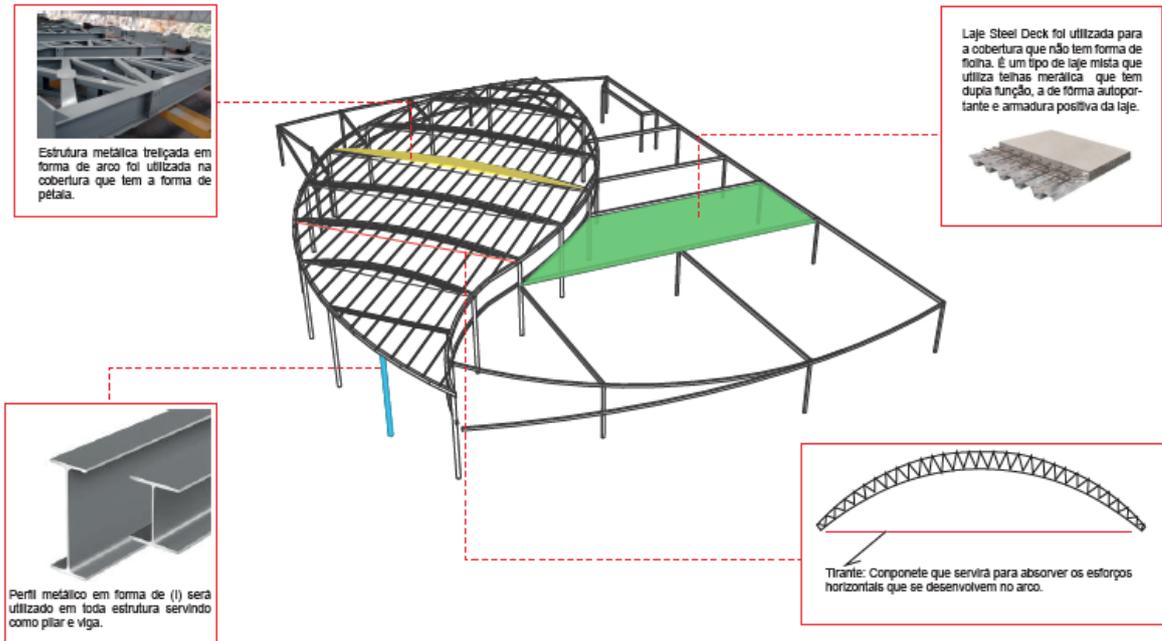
Informações sobre a estrutura. Fonte: Acervo do autor.
